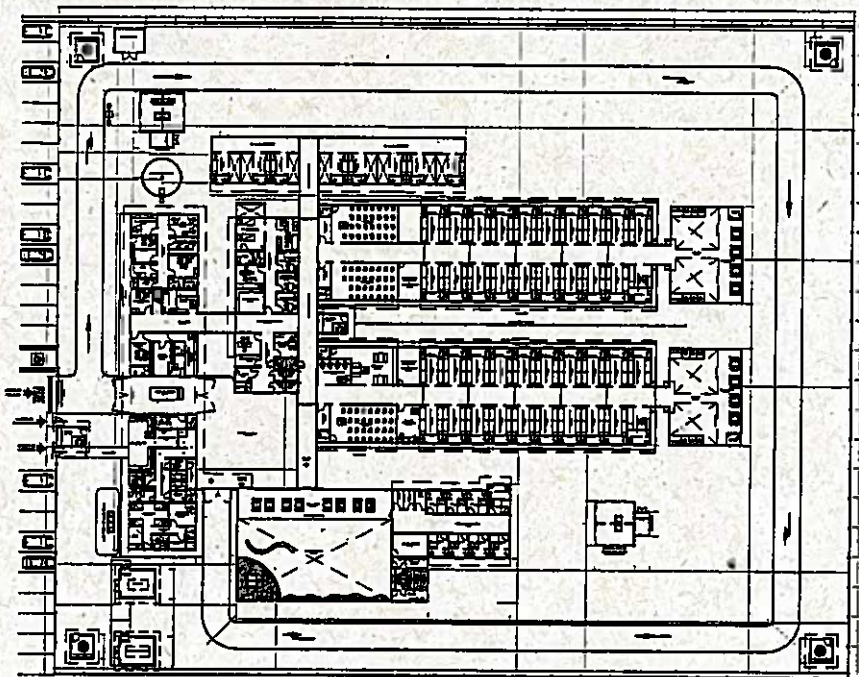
Planta baixa Pavimento Térreo projeto Pará.
